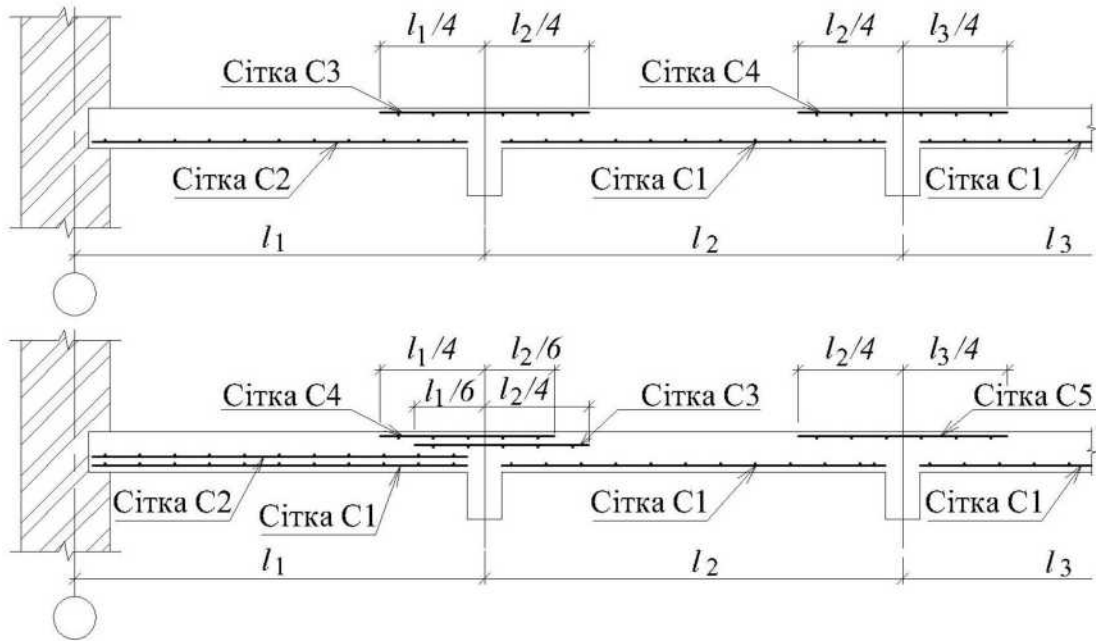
Армування плит зварними сітками з поперечною робочою арматурою (варіанти)
